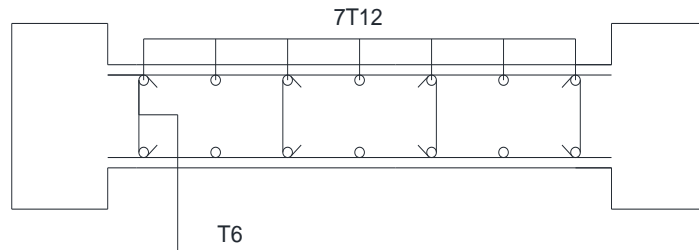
Schéma de ferrailage du voile (poutres normales - plancher au dalles pleines)
